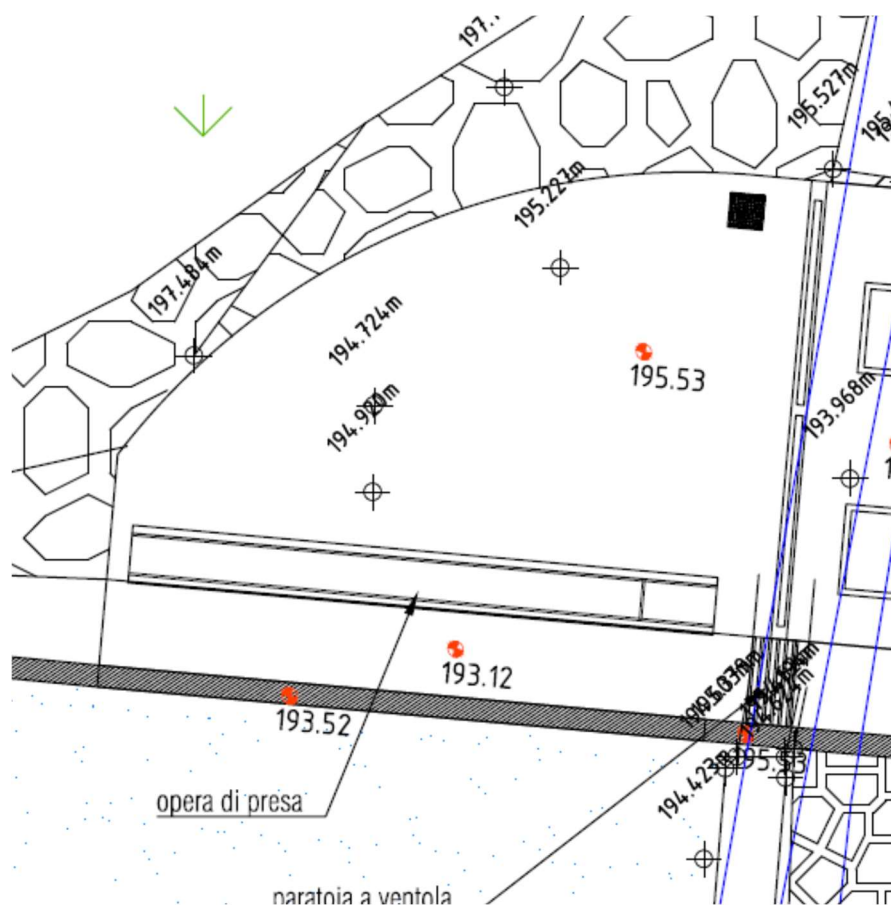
Estratto planimetrico opera di presa e canale di derivazione.
